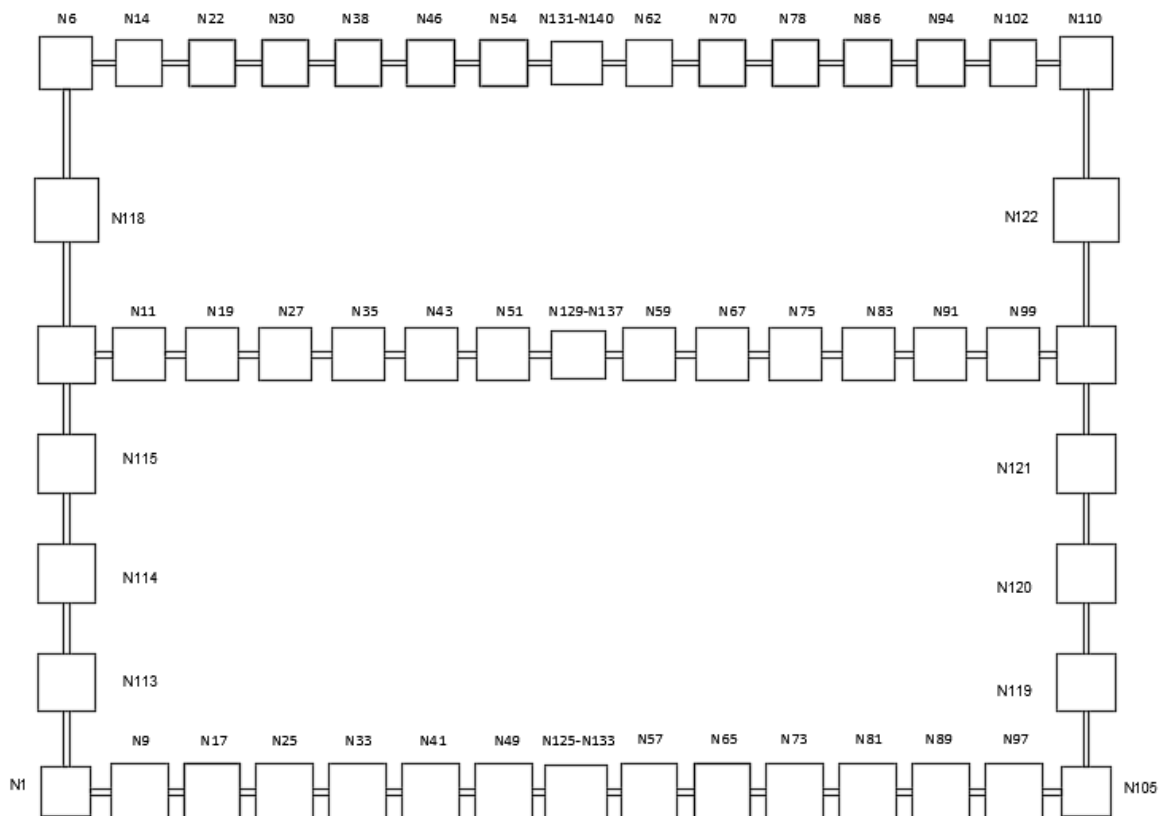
Vista en planta de cimentación. Fuente: Creación Propia.
